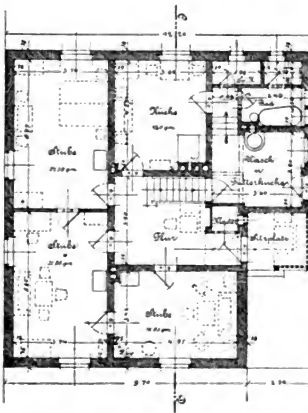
Grundriß zu Abb. 76. Erdgeschoss.
